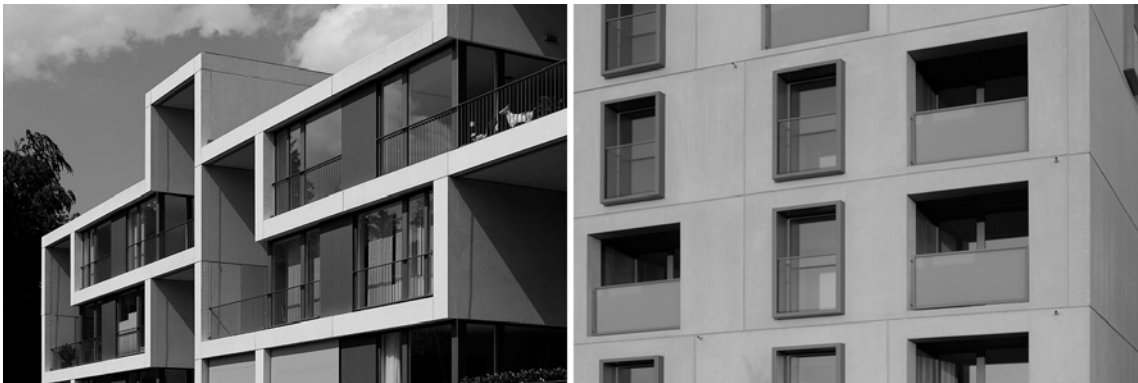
Wohnbauprojekt PileUp (links) und Wohnbau in Neu-Ulm mit fassadenfertigen Bauteilen
